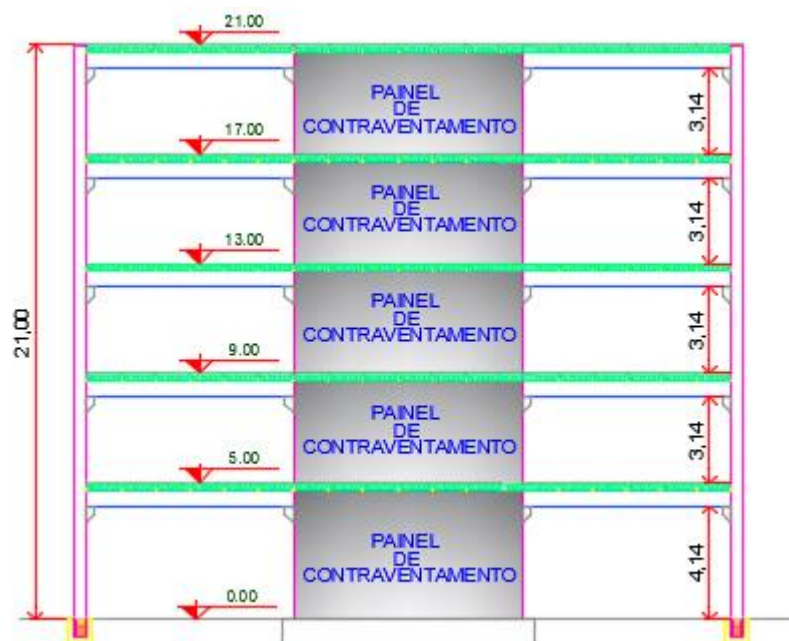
Planta da estrutura contraventada através de painéis de preenchimento
